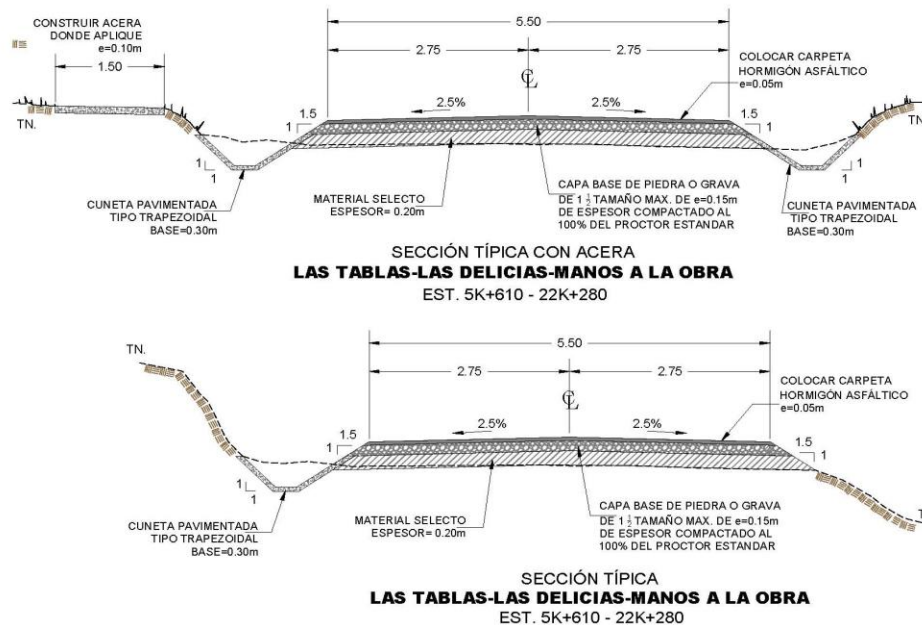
Detalles de sección típica. Fuente: Plano del proyecto
